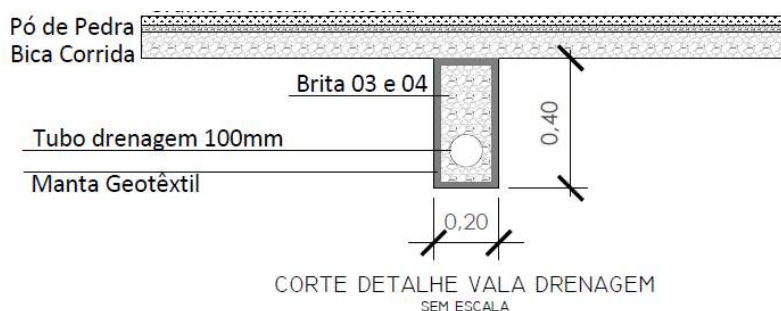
Detalhe de instalação Drenagem (Fonte: Autor/2024)
